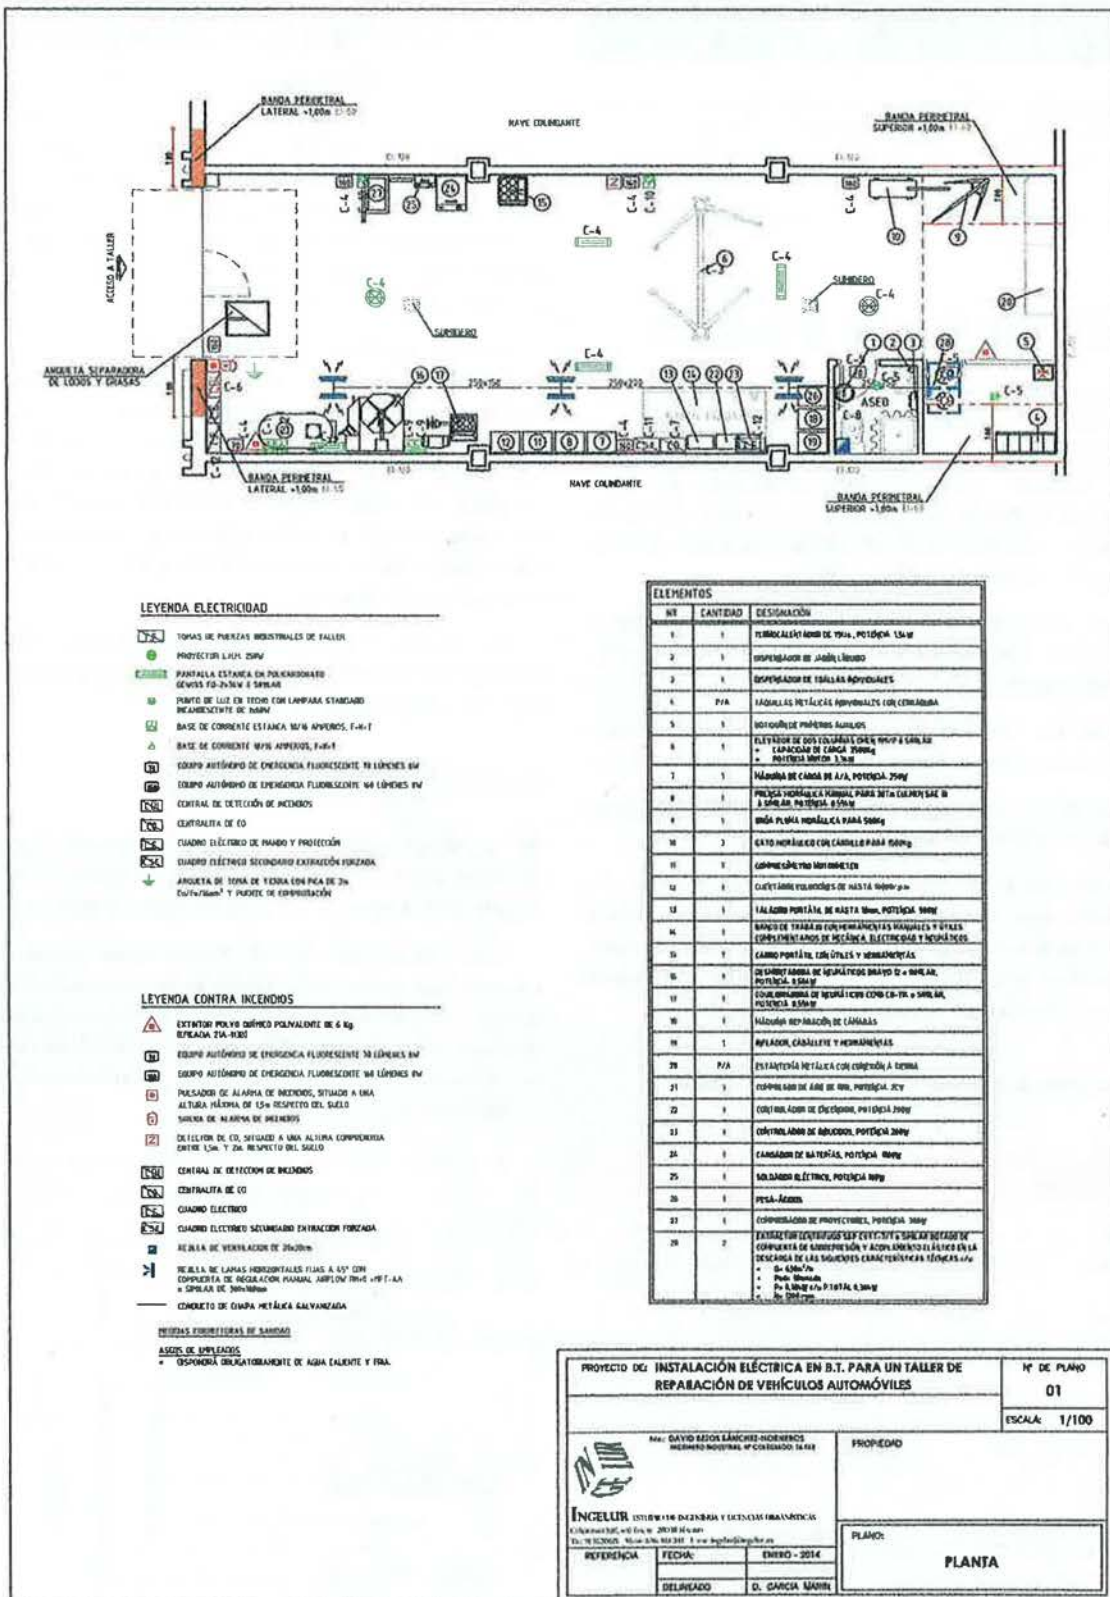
Plano de planta de una industria, en el que se incluyen los equipos e instalaciones eléctricas de alumbrado y fuerza, así como algunos elementos de la instalación contra incendios. (Cortesía de Ingelur.)
